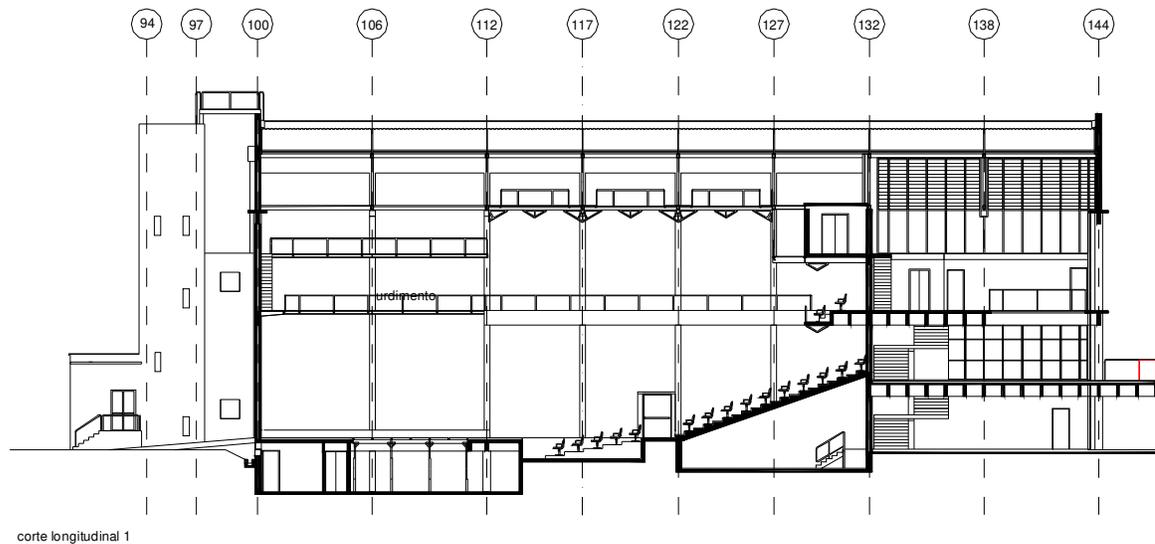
Corte longitudinal 1 – Teatro Santa Cruz – Sem Escala
